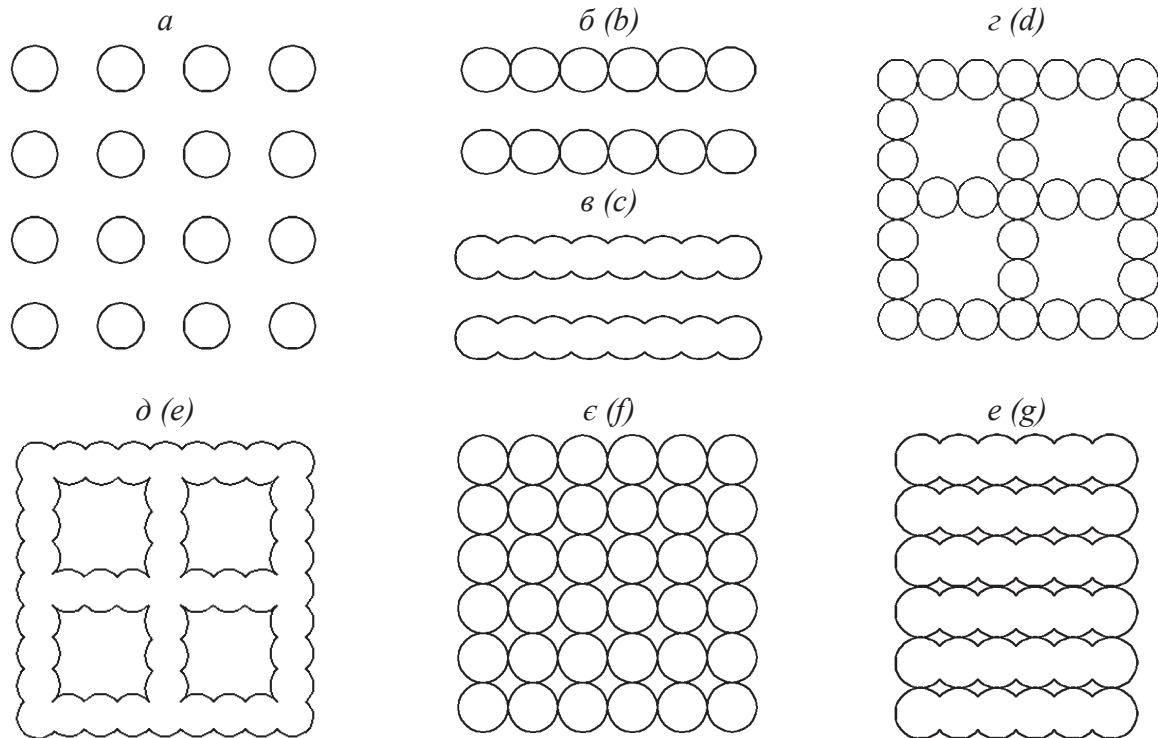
Конструктивні рішення закріплення ґрунтів ґрунтоцементними елементами: а – окремо розташовані ГЦЕ; б, в – панелі з ГЦЕ; г, д – сітки з ГЦЕ; е, е – блоки з ГЦЕ / Fig. 2. Structural solutions of consolidation of soil with soil cement elements: a – separate SCE; b, c – panels with SCE; d, e – grids with SCE; f, g – blocks with SCE
